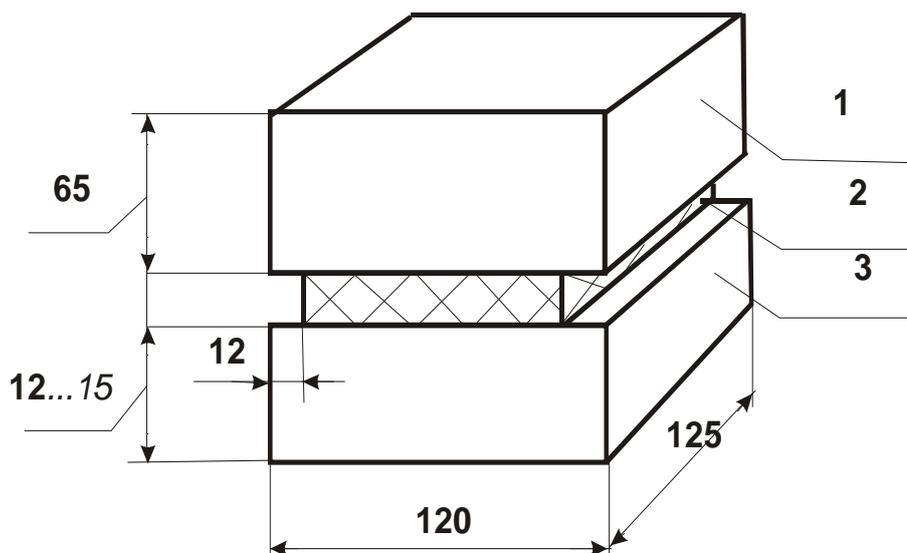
Схема образца для испытаний на прочность сцепления:
